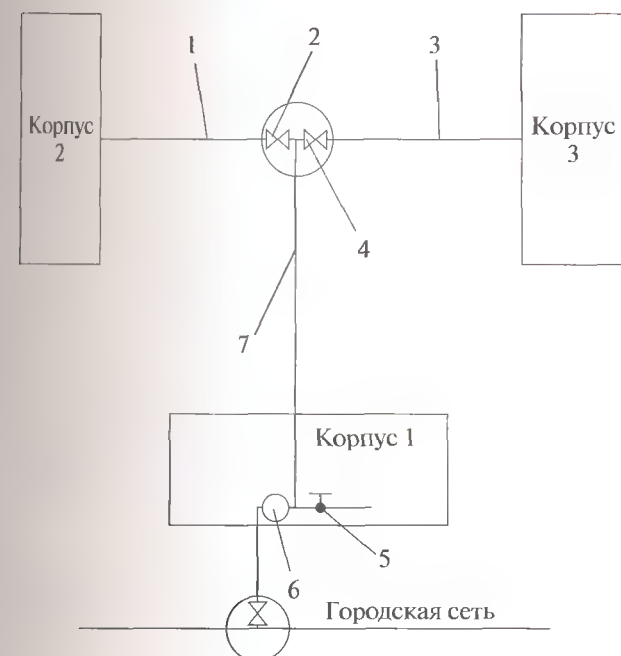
Определение места утечки воды из труб дворовой водопроводной сети
